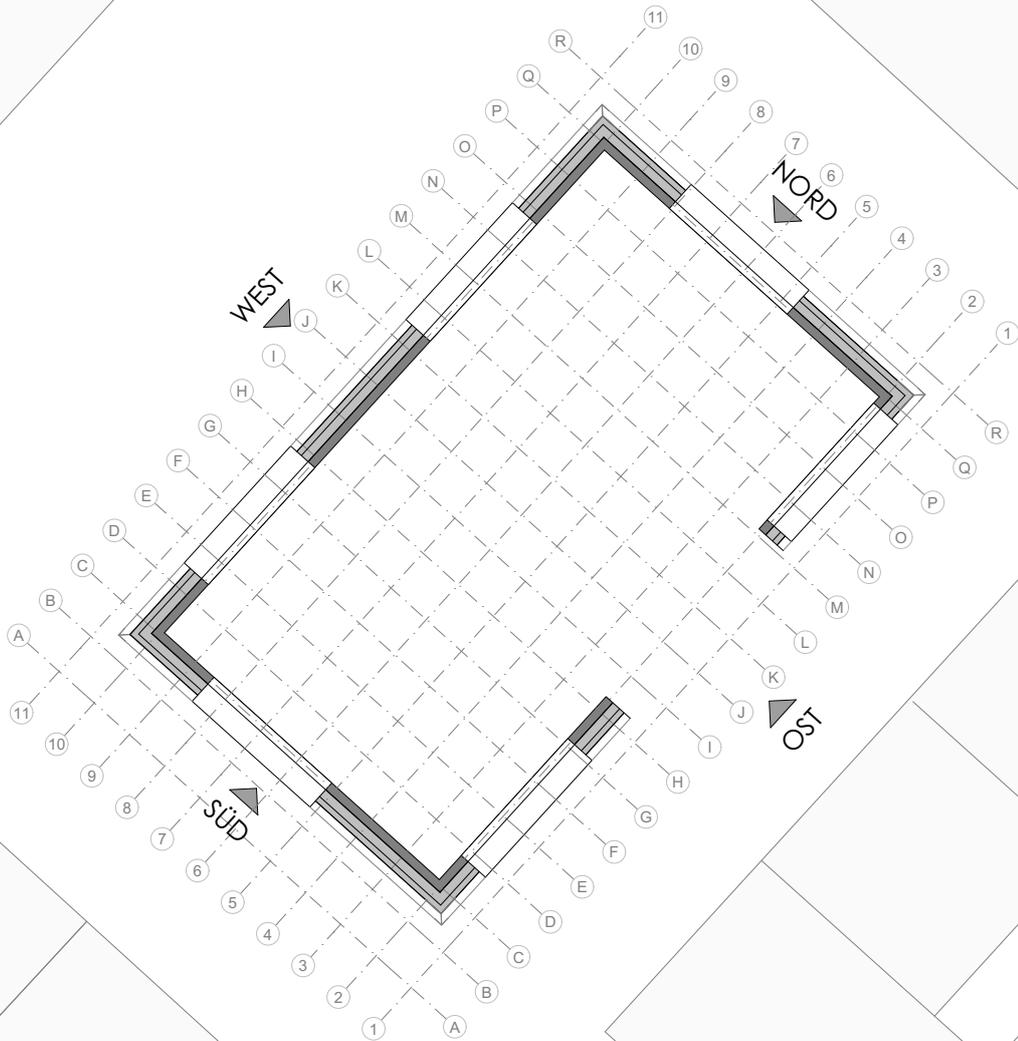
Grundriss 1:100 [eigene Darstellung]
